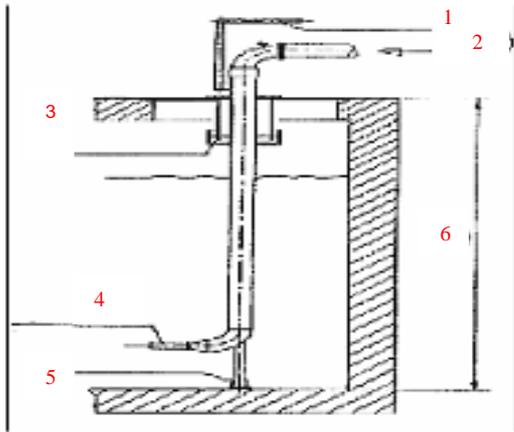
Mélangeur hydraulique rotatoire de type (KTS).
